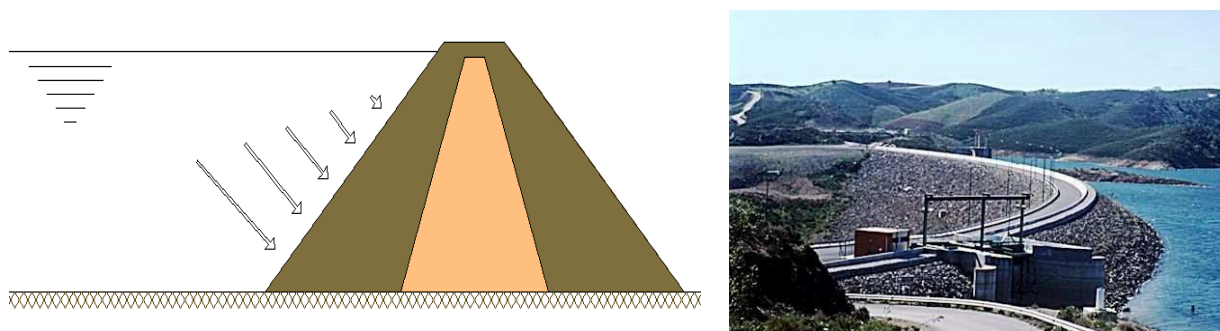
Barragens de aterro. Perfil esquemático e barragem de Beliche (Portugal, 1986) (fonte: www.cnpqb.inag.pt).
